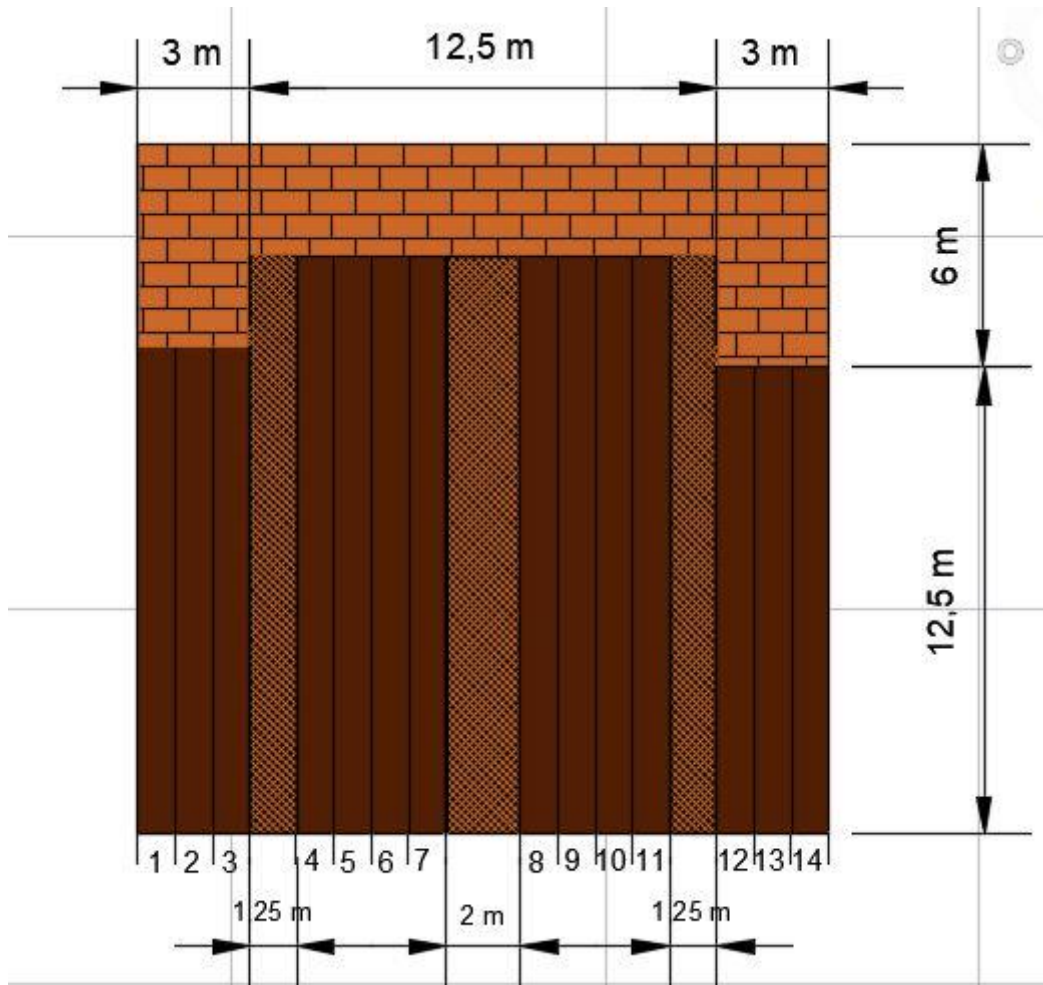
Plano zona Rupícolas. Fuente: elaboración propia
